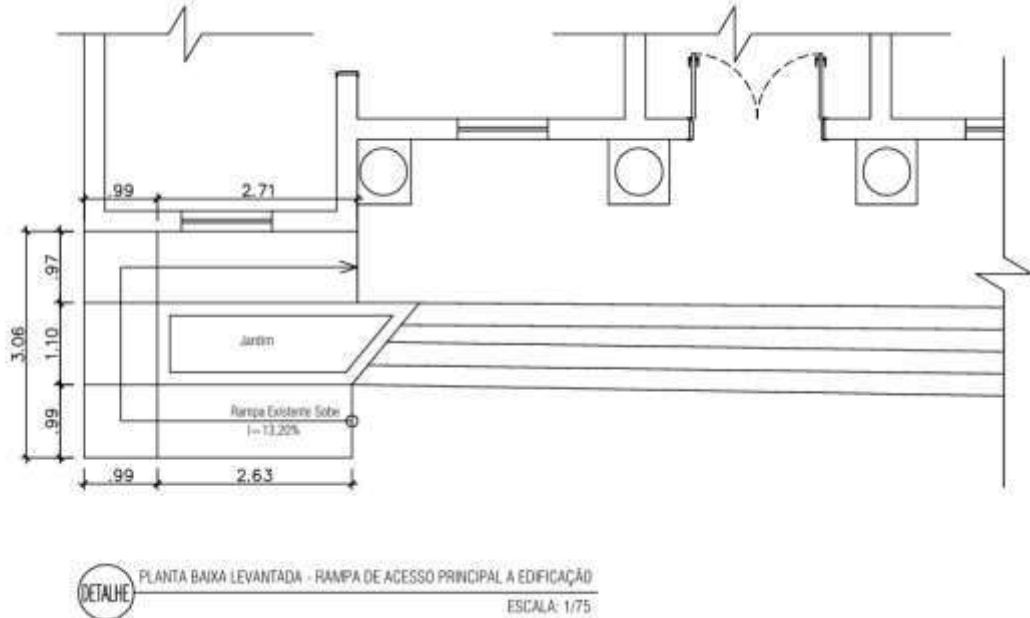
Planta de levantamento da rampa de acesso atual (sem escala)
